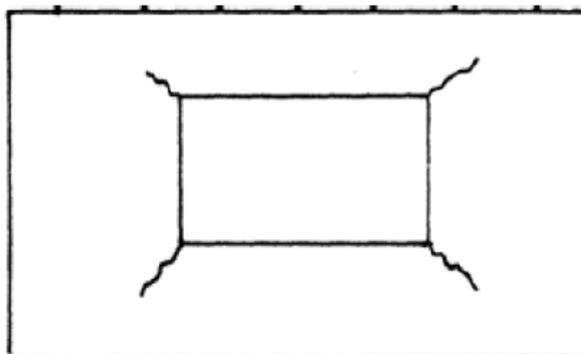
FISSURAÇÃO DE ALVENARIA NO CONTORNO DE VÃO DE JANELA
